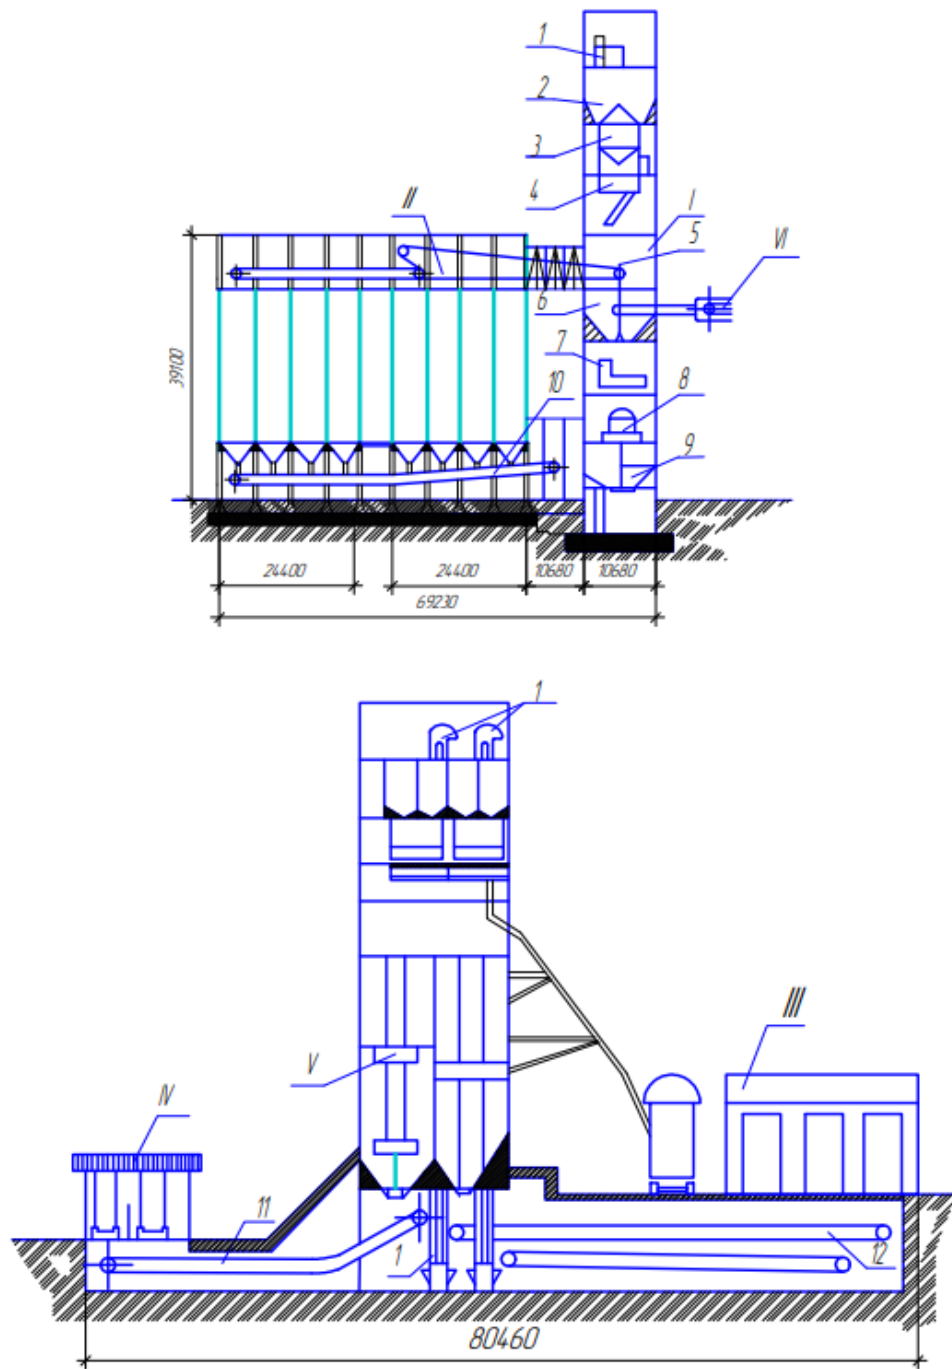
Схема елеватора: I – робоча вежа; II – силосний корпус; III – приймальний пристрій із залізниці, IV – приймальний пристрій із автотранспорту; V – зерносушарка; VI – галерея відпустки на млин; 1 – норії, 2 – надважковий бункер, 3 – ковшові ваги, 4 – розподільні труби, 5 – надсилосний транспортер, 6 – надсепараторний бункер, 7 – сепаратор, 8 – контрольний сепаратор, 9 – підсепараторний бункер, 10 – підсилосний транспортер приймальний транспортер з автотранспорту, 11 – приймальний транспортер із залізниці
